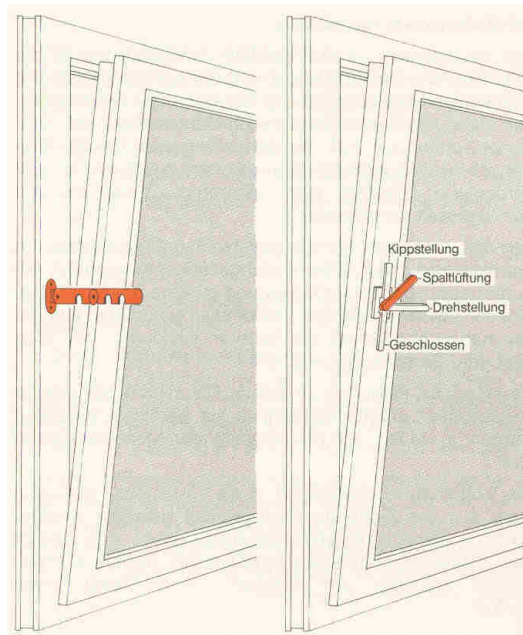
Möglichkeiten zum Einstellen eines Fensterspalts: Feststellhaken (links) und Kippbeschlag (rechts) mit 4 Stellungen: Kipp, Spalt, Dreh, geschlossen)
